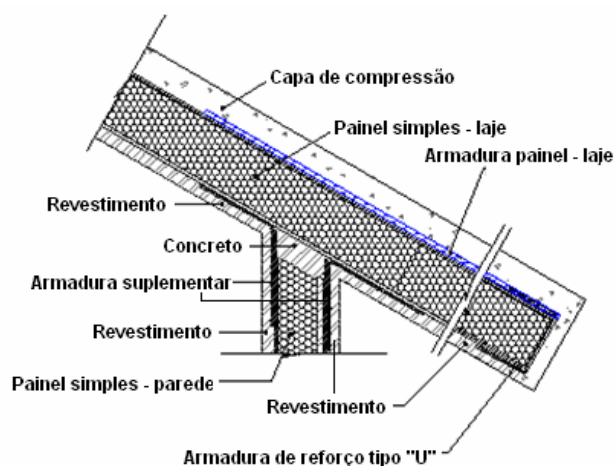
Detalhe encontro painel parede e painel laje - cobertura inclinada
